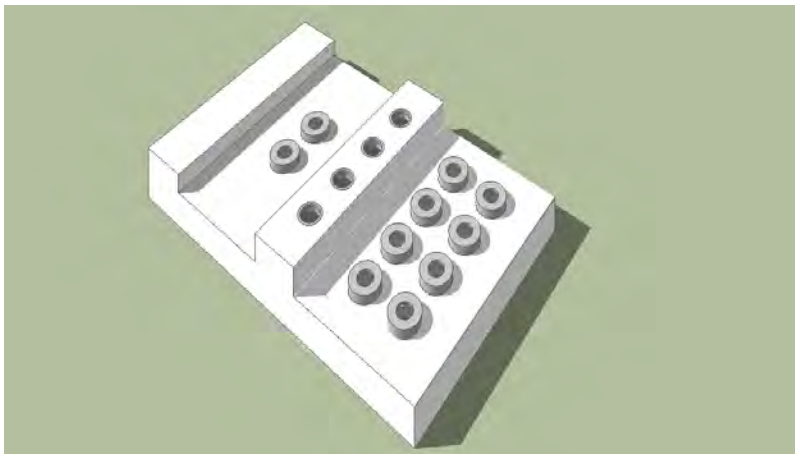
Lucernarios principales de la iglesia (cilindros de hormigón).
